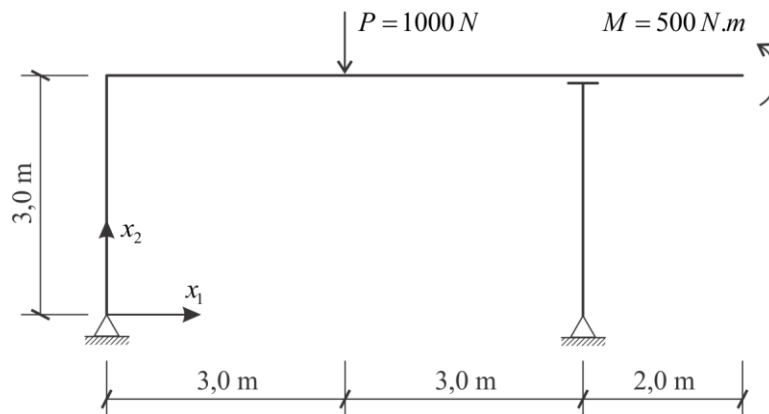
Pórtico com ligação deslizante na ligação viga-pilar
